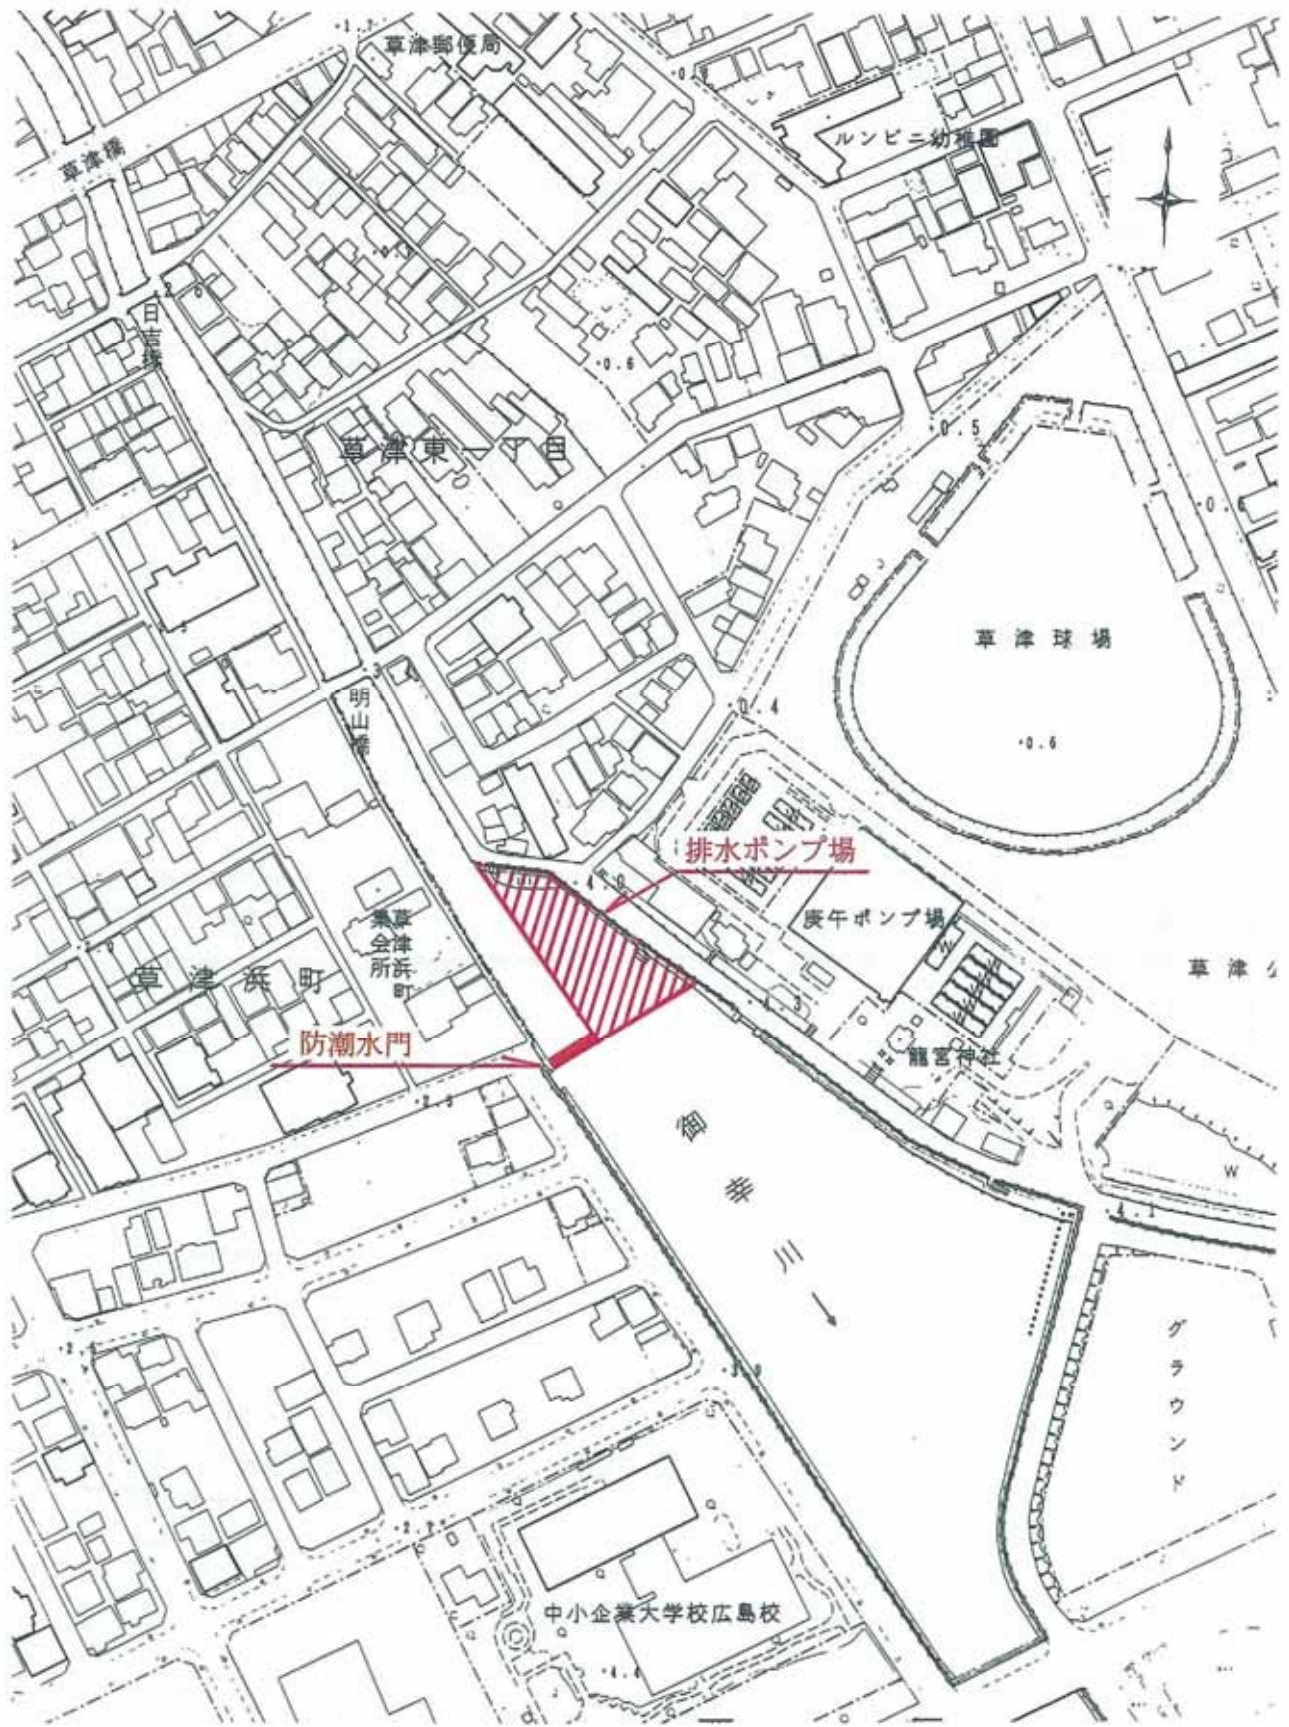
(8) 平面図(御幸川) (S=1:2,500)
